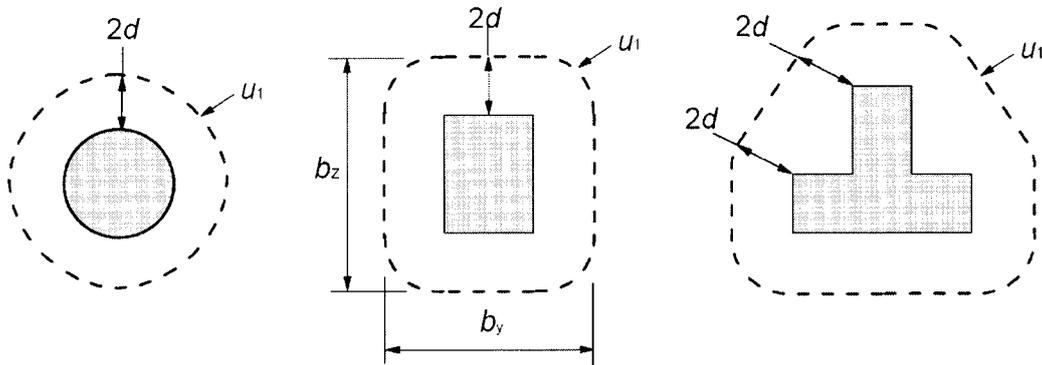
Typische kritische Rundschnitte um Lasteinleitungsflächen
